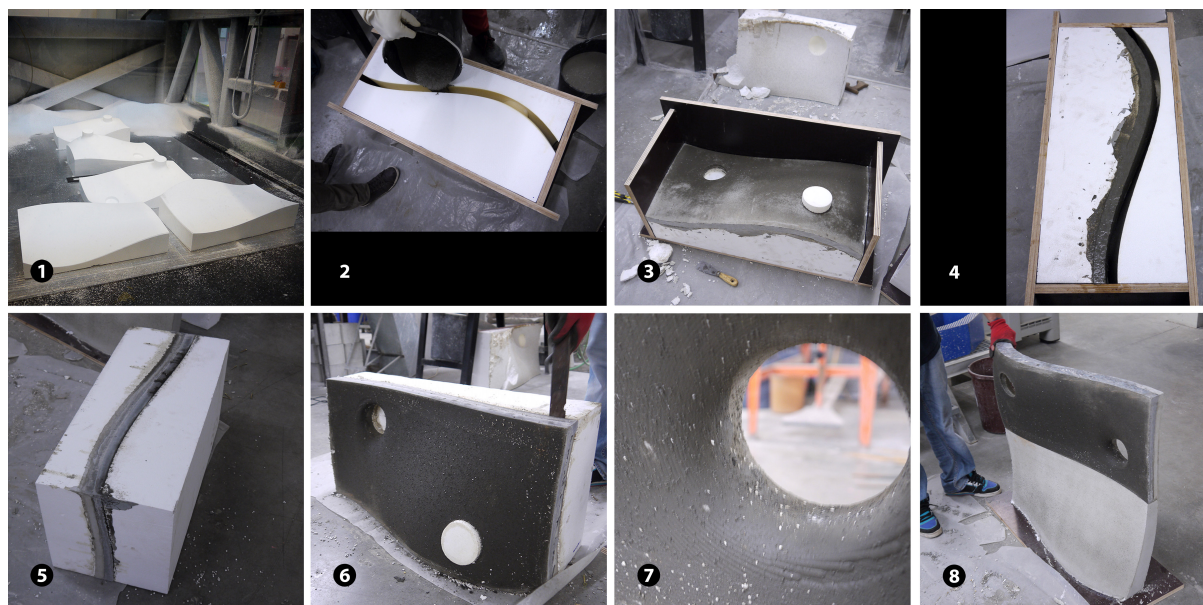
1 - Moldes, 2 - Primeira betonagem, 3 - Descofragem, 4 - Montagem do segundo molde, 5 - Segunda cura, 6 - Descofragem, 7 - Detalhe da superfície, 8 - Painéis montados
